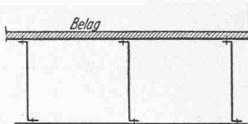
Leichte Decke als Stahl-Hohlkörper ausgebildet
